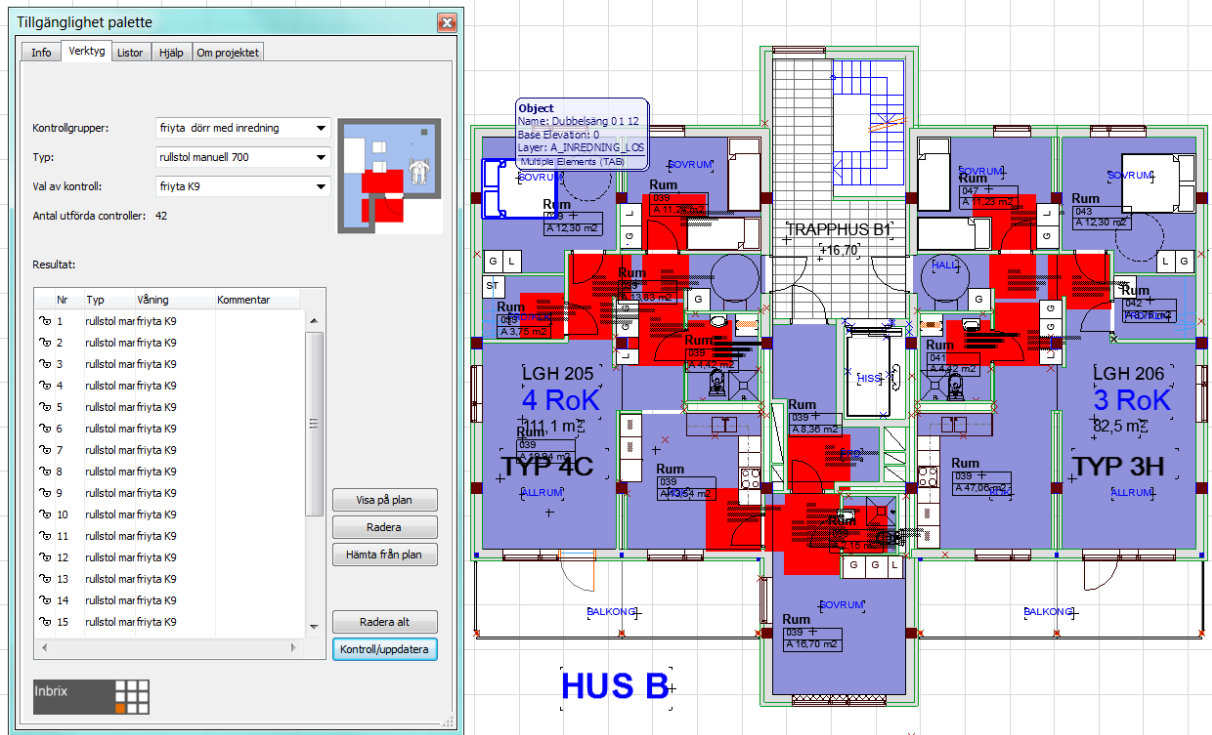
Test dagöppning dörrar K9 och K10, visa på plan.
